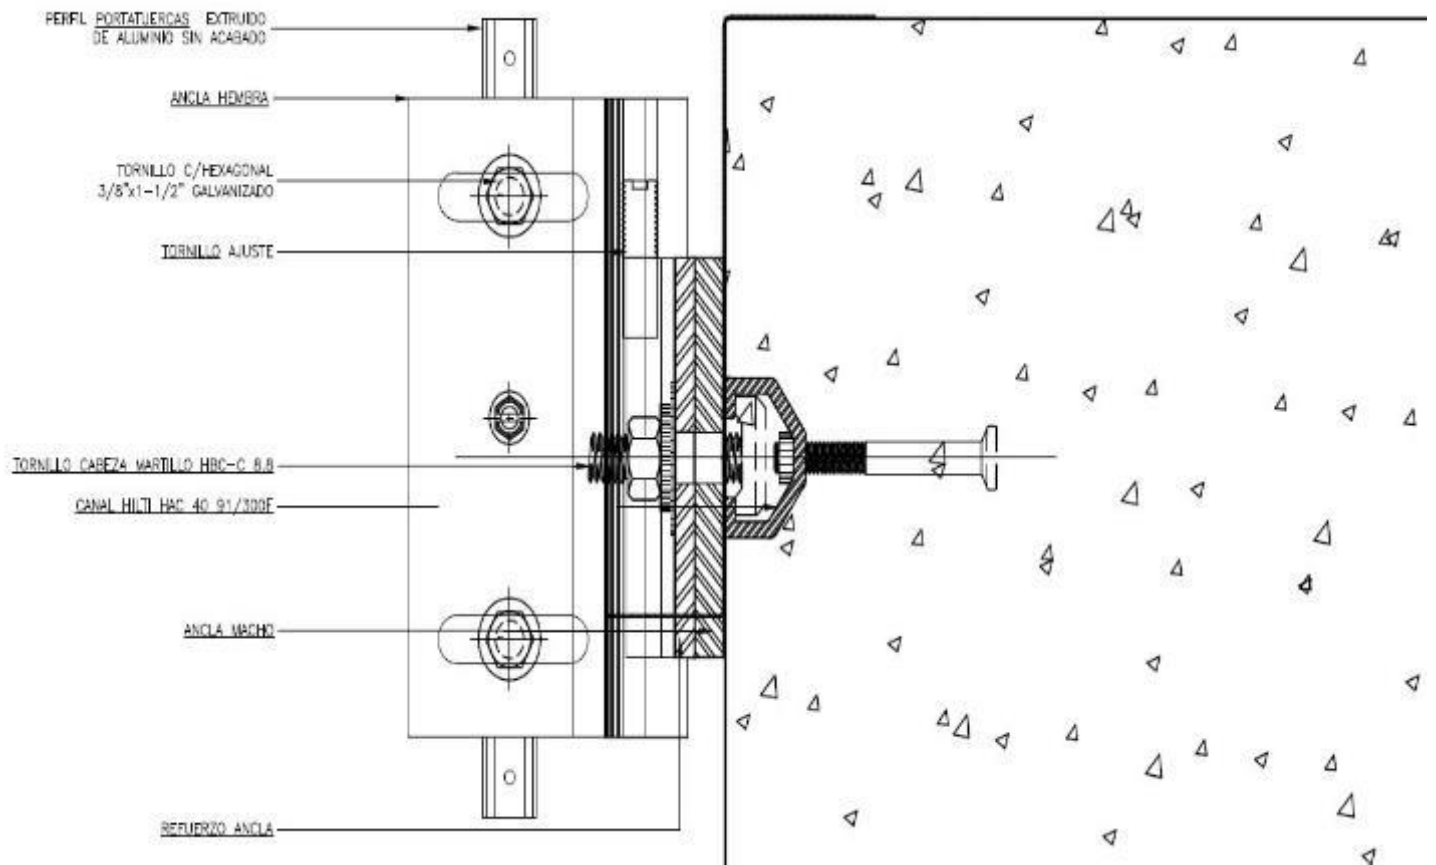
Detalle de instalación. Fuente: Extralum y propia (2020)
